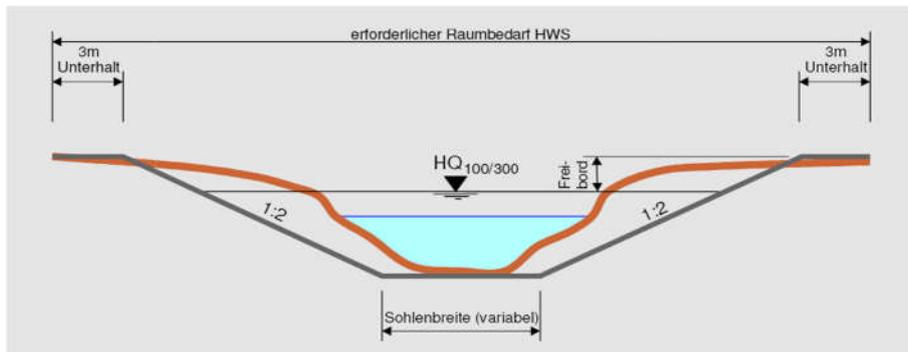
Querprofilbetrachtung für Fließgewässer ohne Damm (gewaesserraum.ch)
